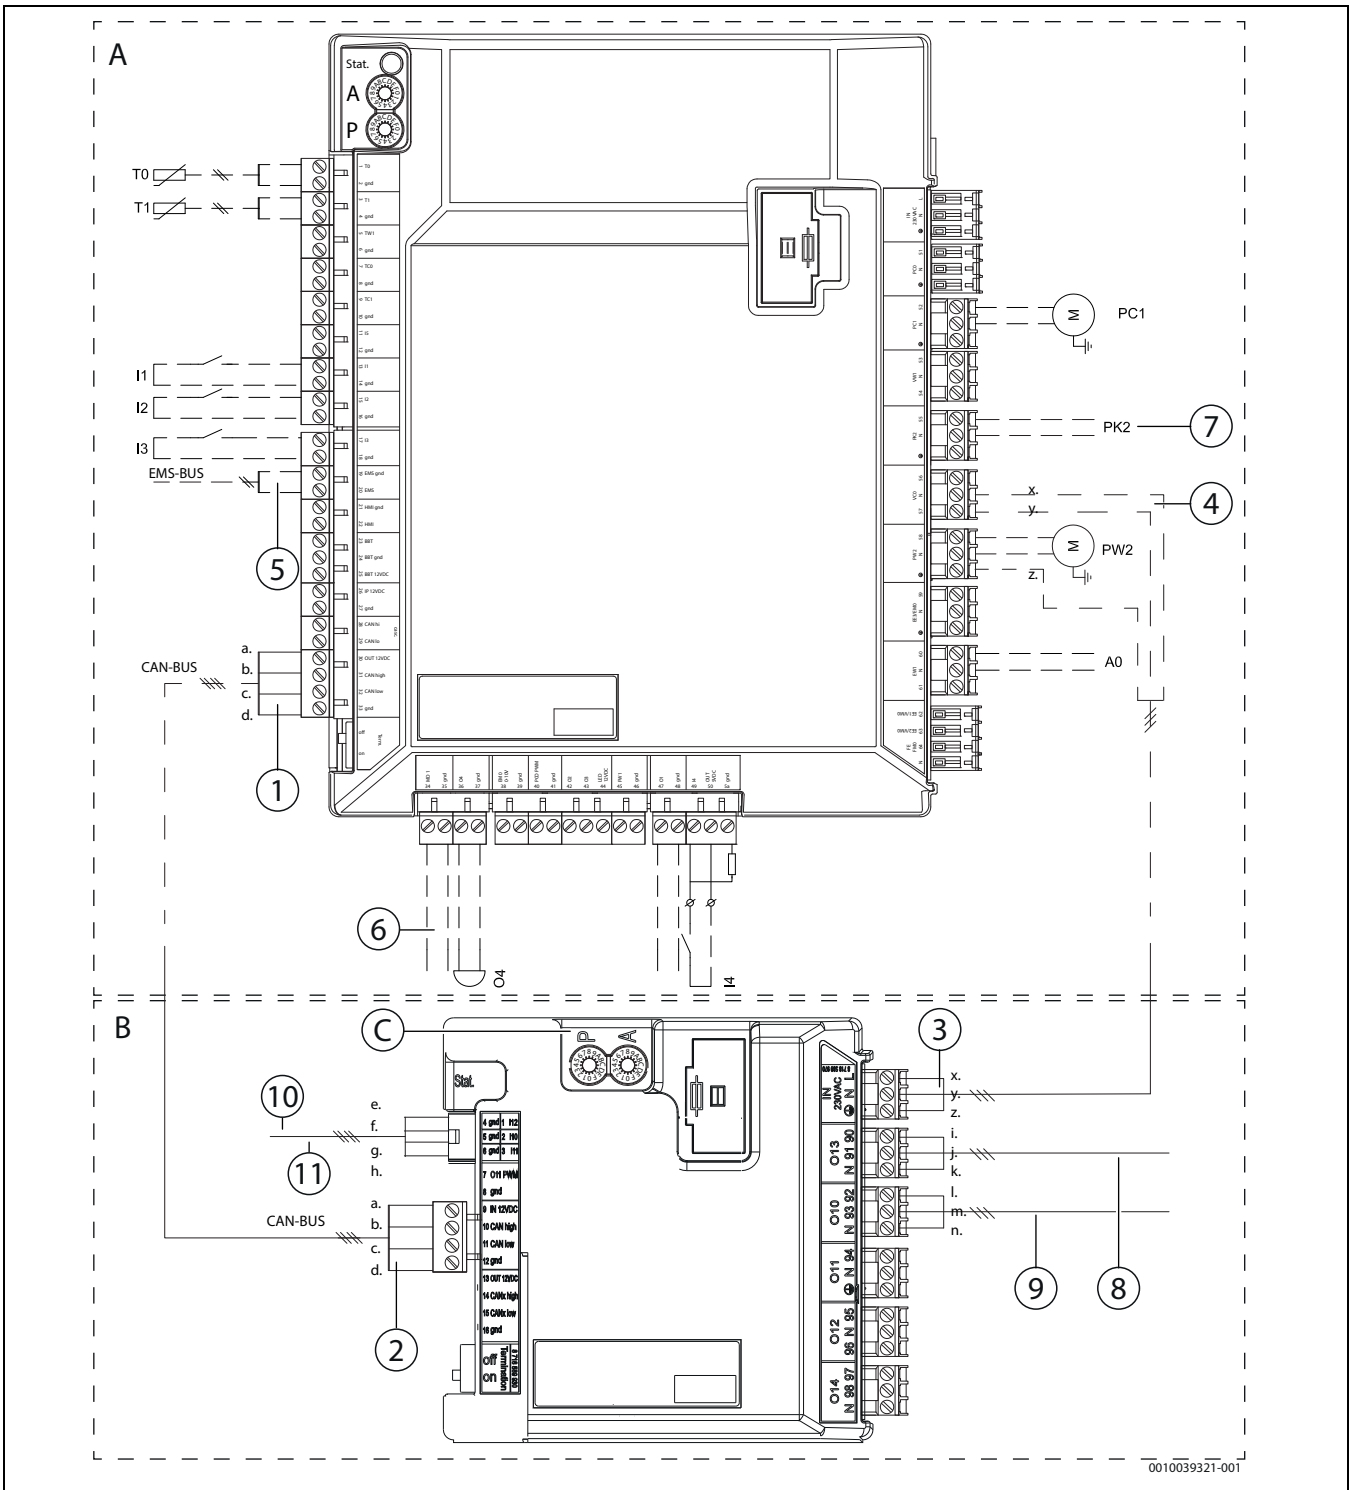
Krettschema extensionboard (kylstationen) och installerboard (värmepumpen)
